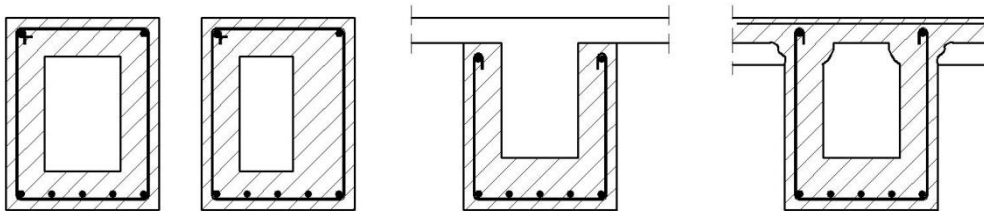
Cămășuiele ale grinzilor din beton armat
